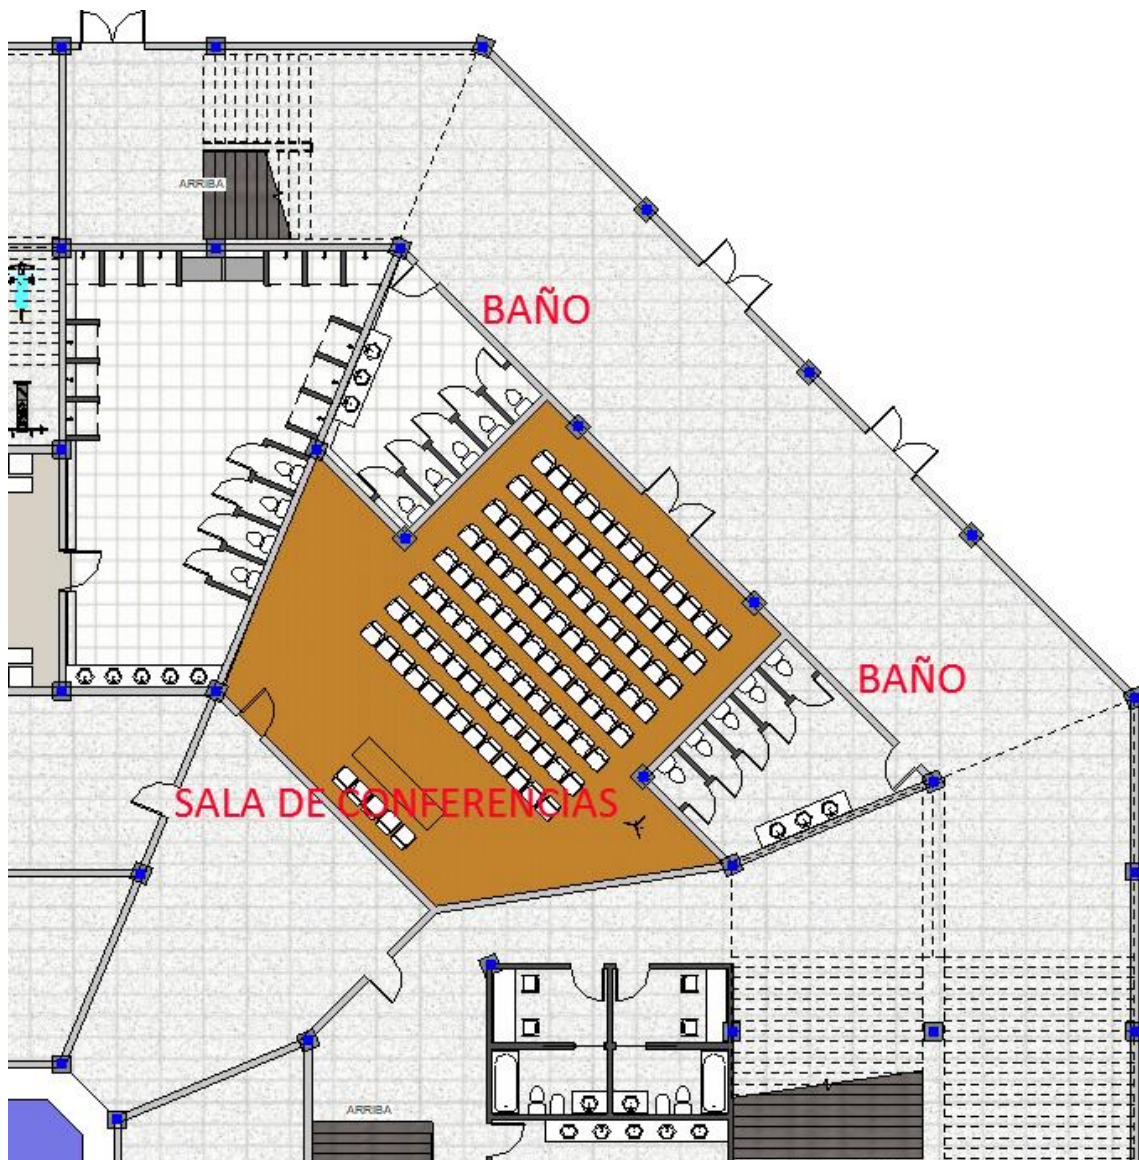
Vista en planta del codo noreste. Fuente: elaboración propia
